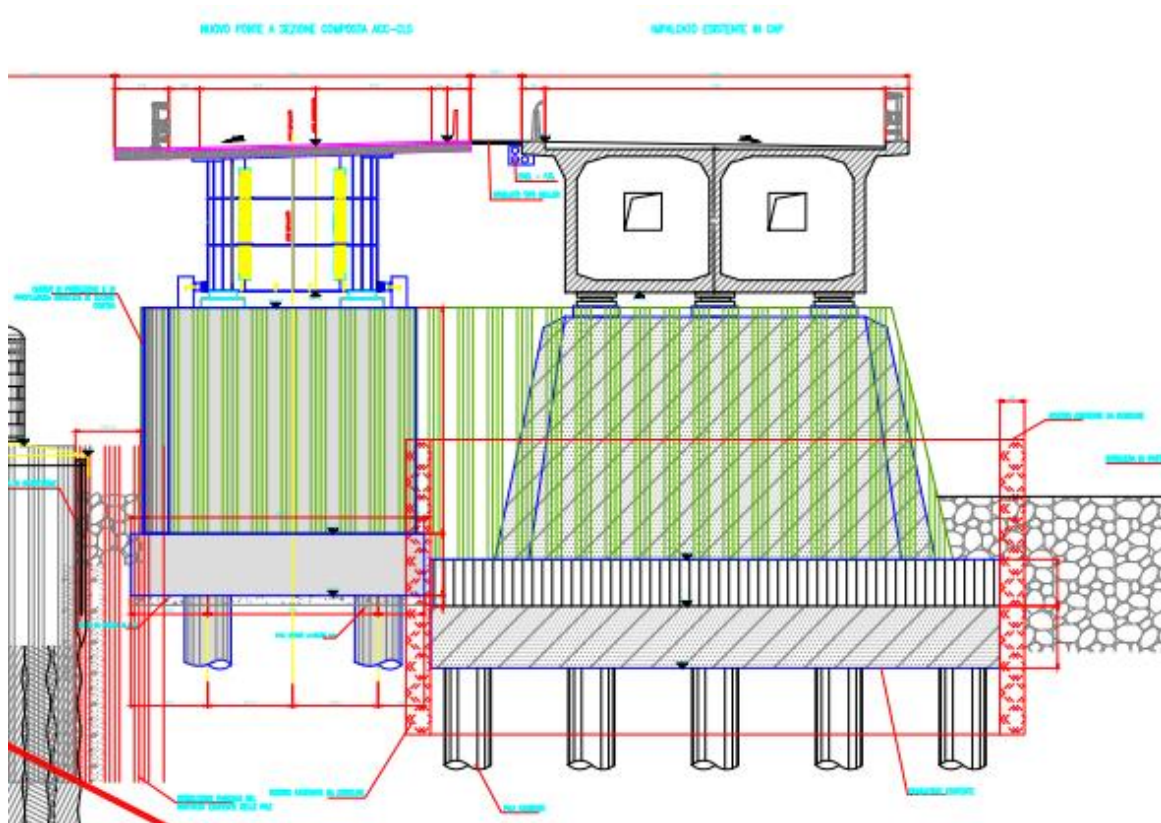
Sezione trasversale del nuovo ponte in progetto
